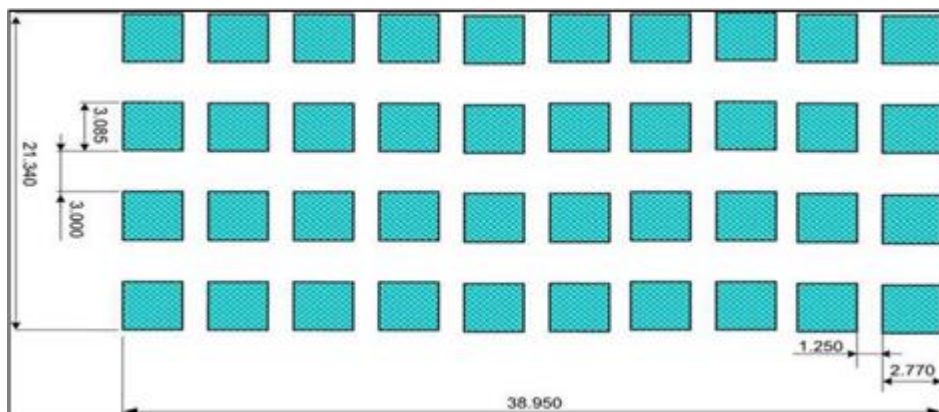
Disposizione planimetrica dei Vaporizzatori
